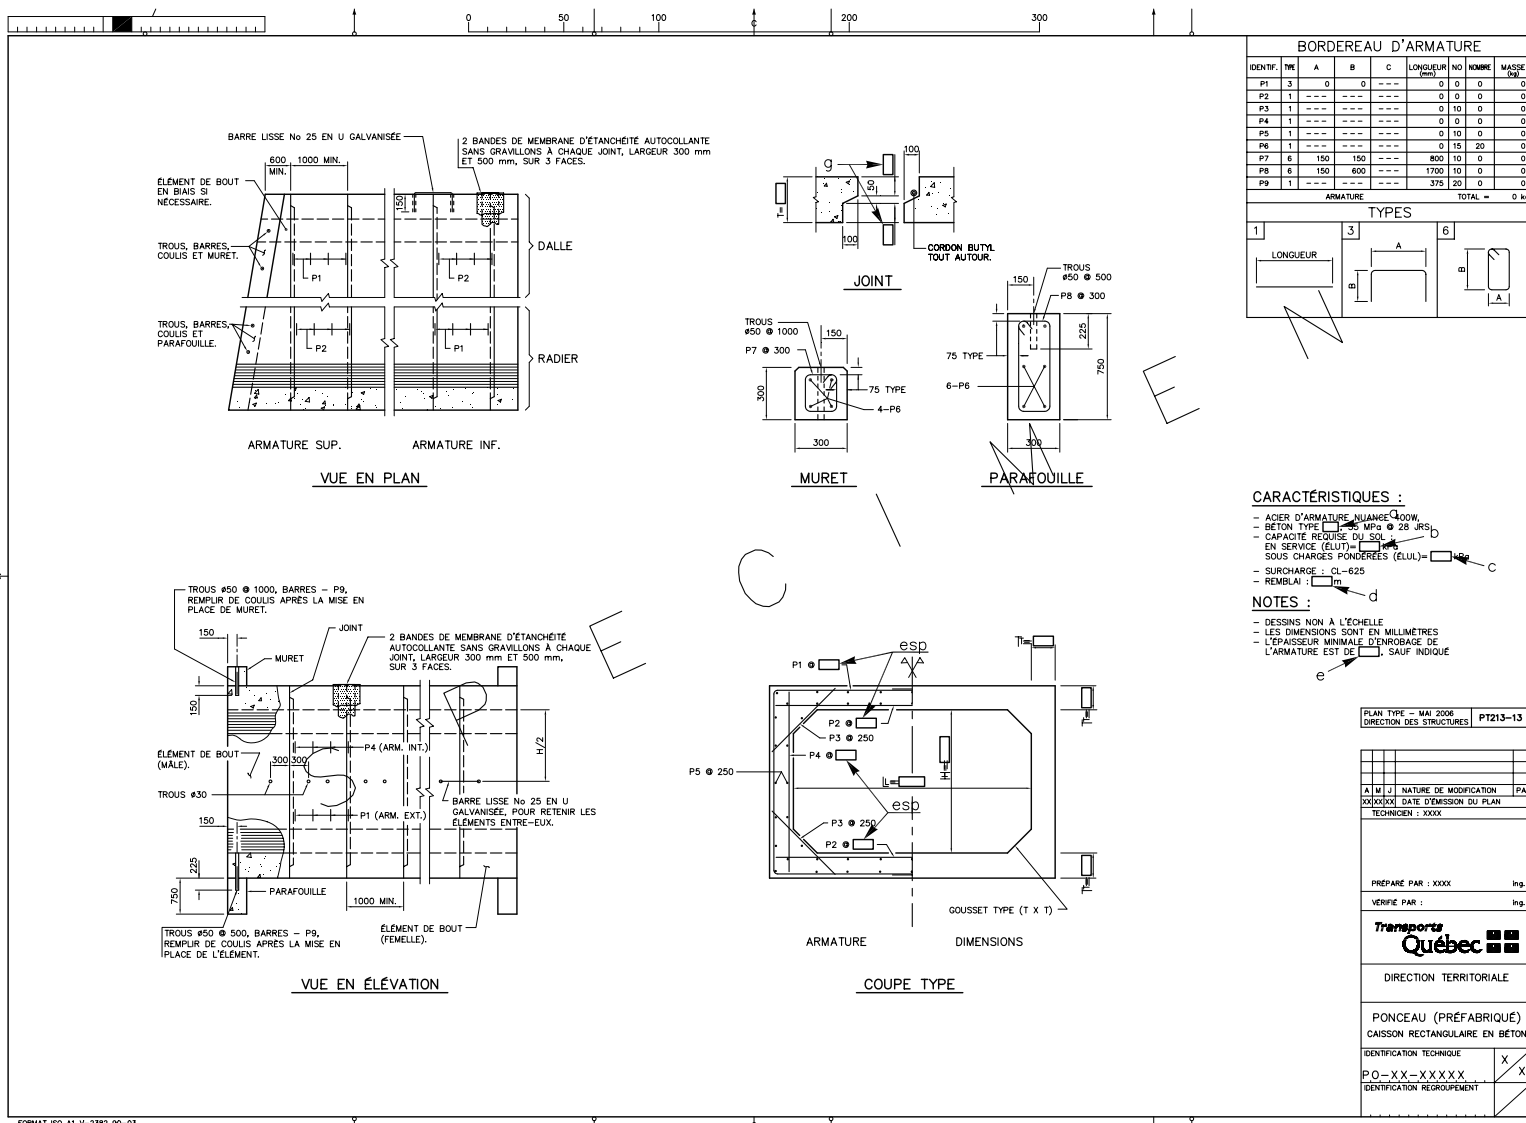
Ponceau rectangulaire en béton armé – Plan type PT213-13
